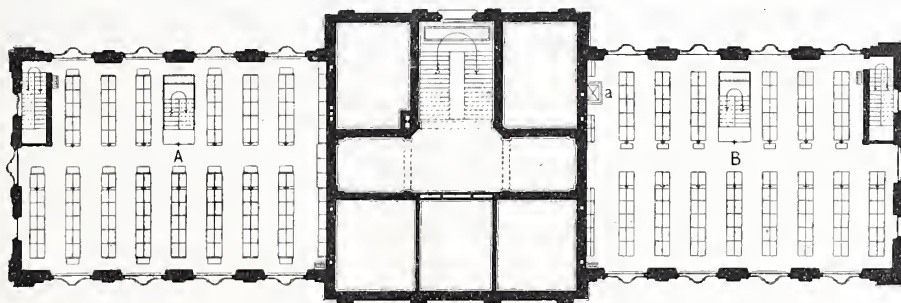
Grundriss vom Zwischengeschoss 1 : 500.
